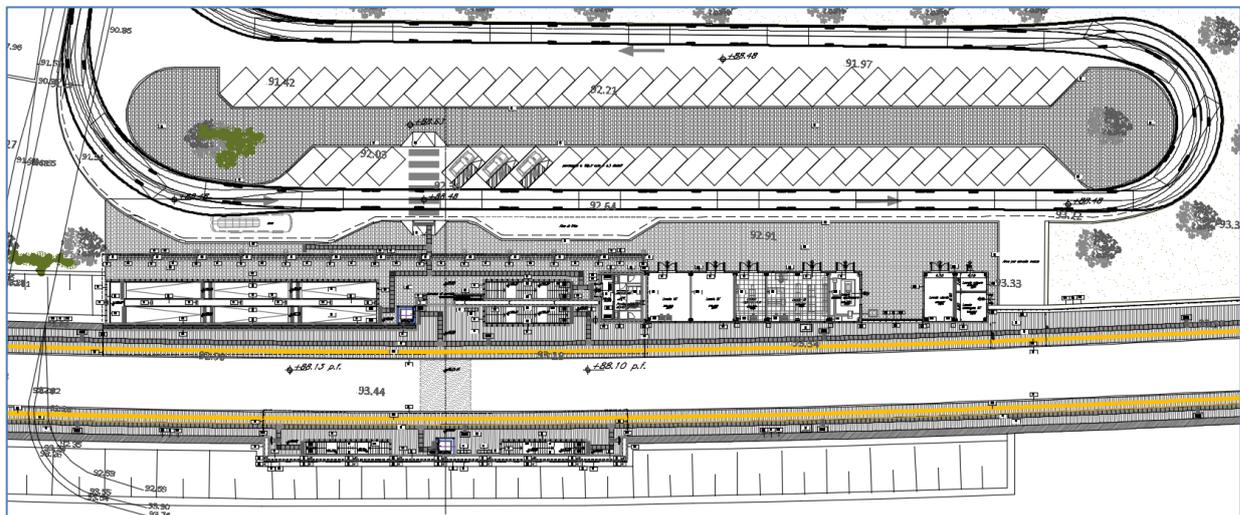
Fermata Ponte Casalduni – Planimetria piazzale (Rif. [49])
